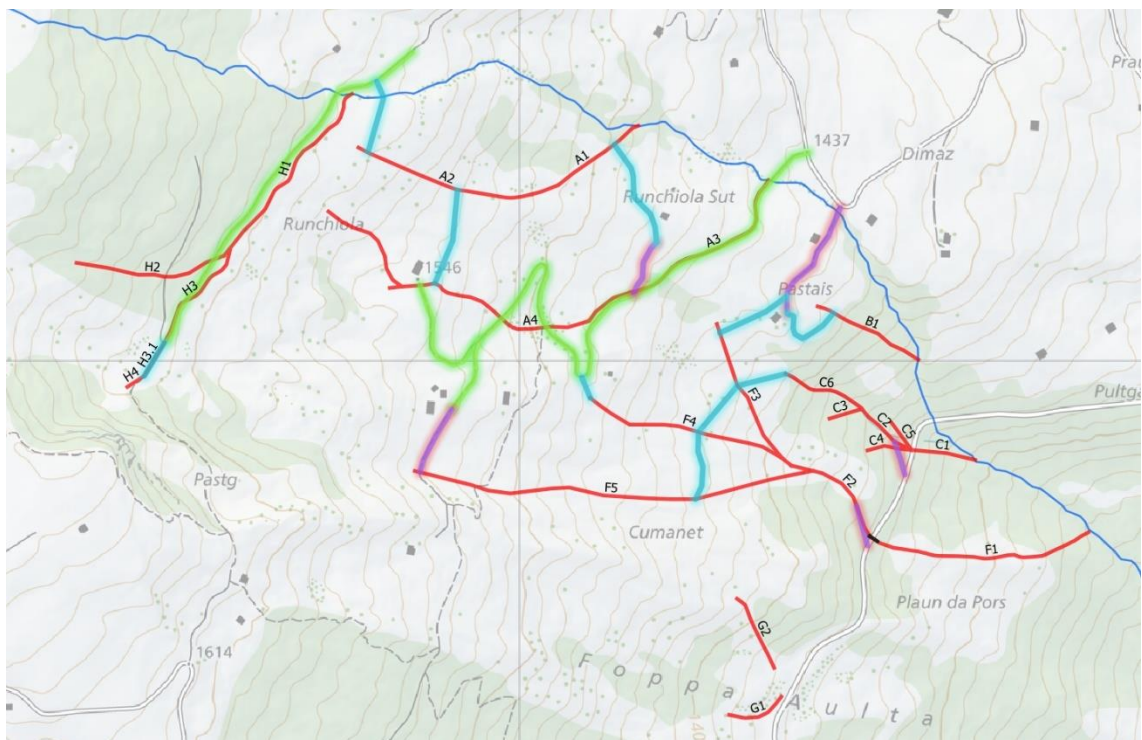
Übersichtsplan, ergänzt mit bestehenden Wegen (grün) und bestehende Zufahrten (violett) und möglichen temporären Erschliessungen für den Bau (blau).
